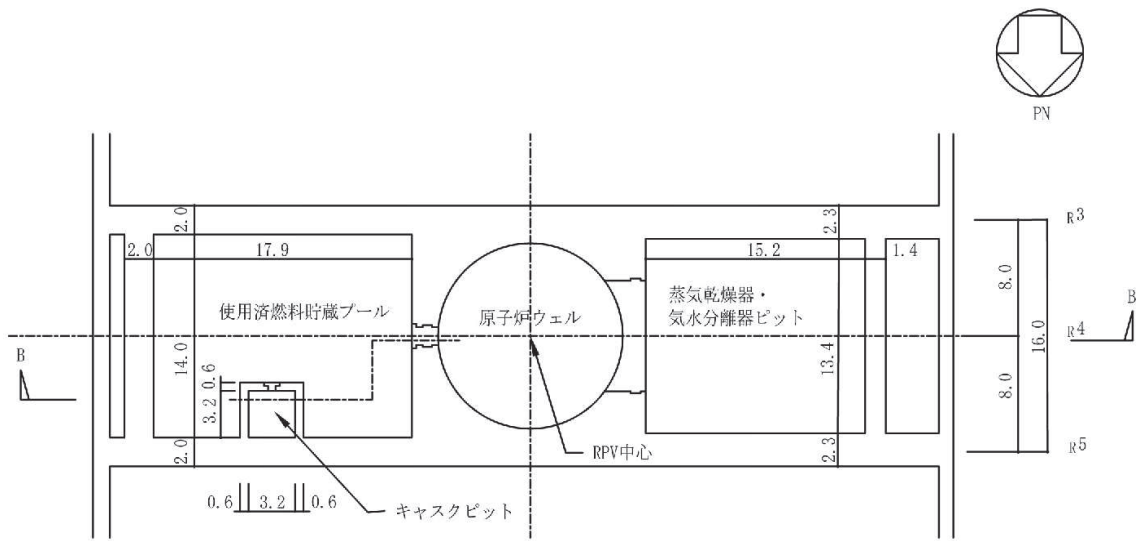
使用済燃料プール周りの概略平面図（単位：m）
